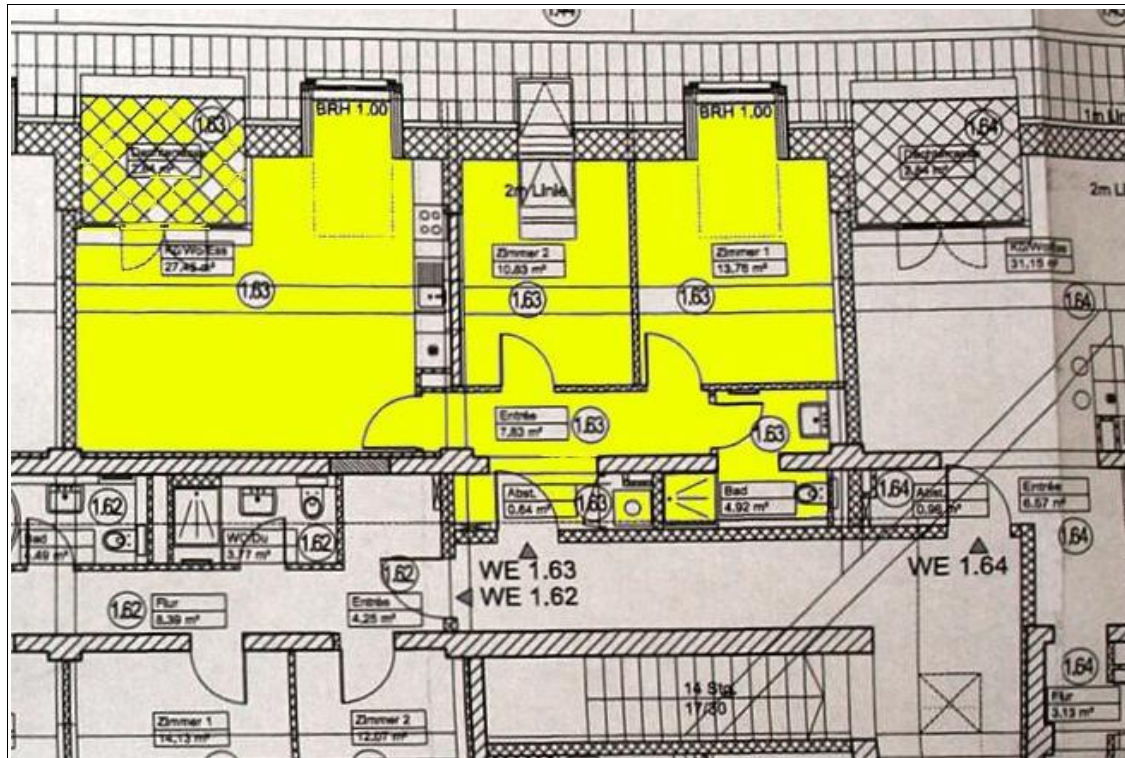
Grundriss des SE Nr. 1.63, Ferdinand-Magellan-Straße 38 im DG gelegen
